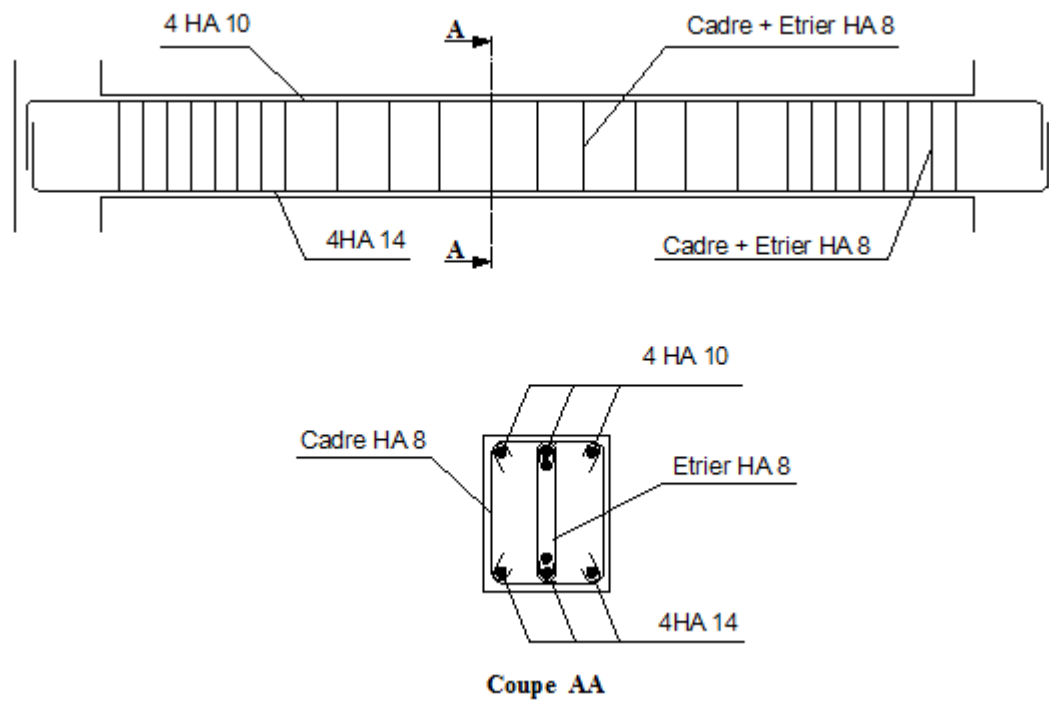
Ferrailage de la poutre palière Non brisée.
